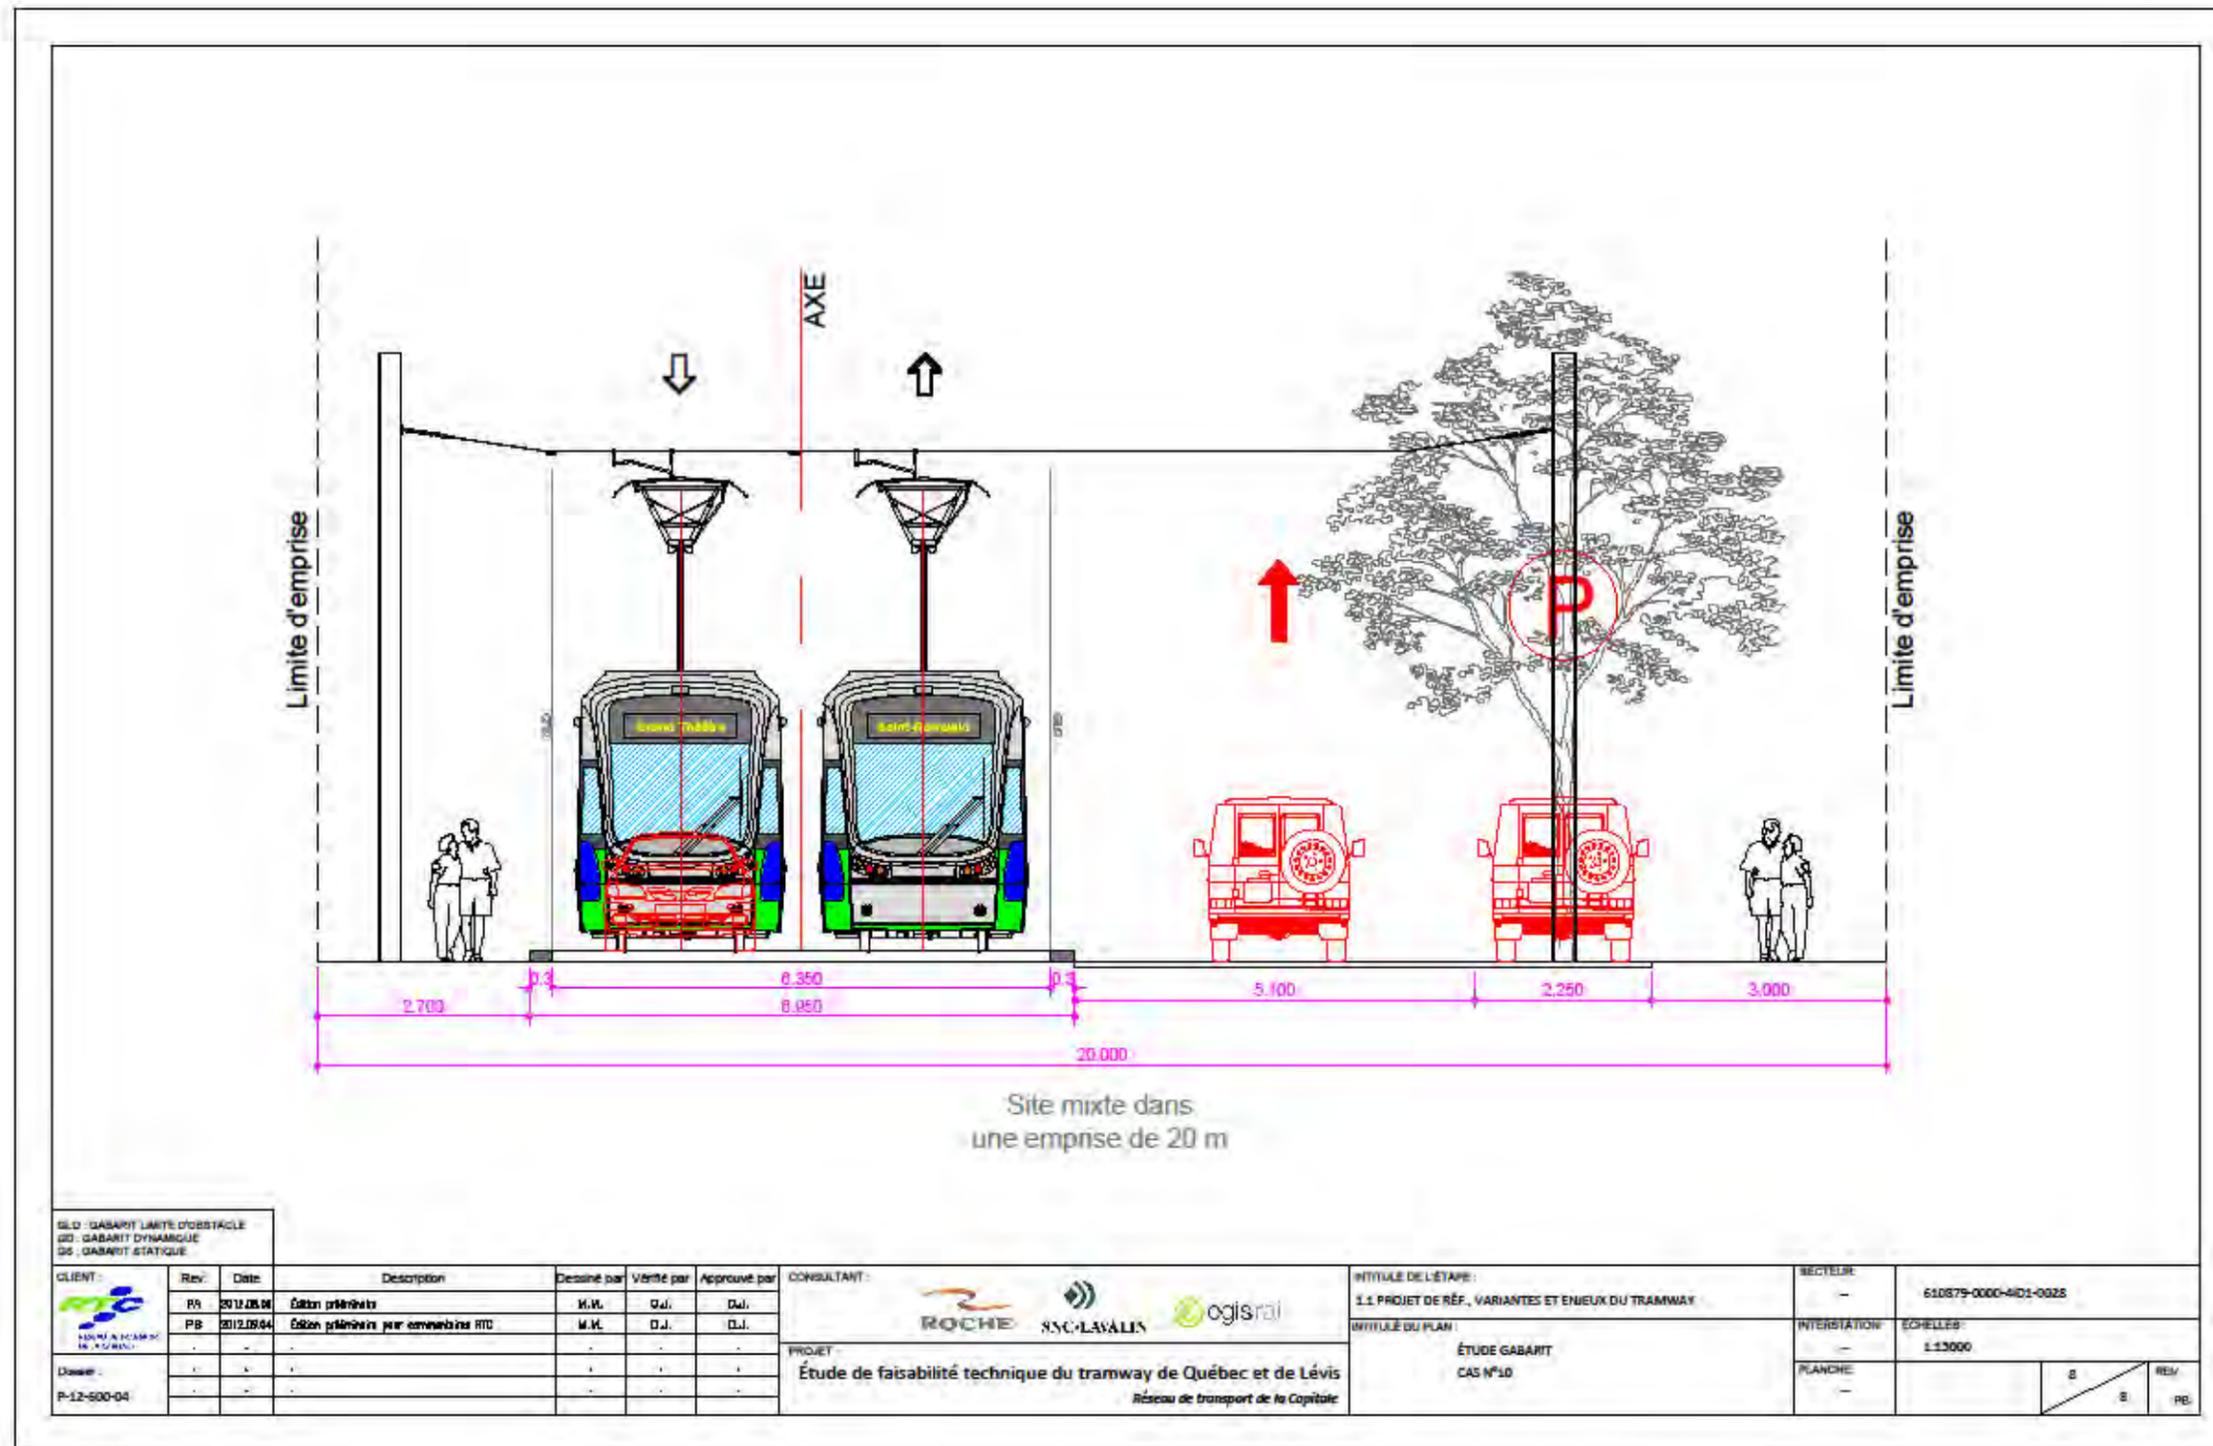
Planche 8 de 8 – Site mixte dans une emprise de 20 m
